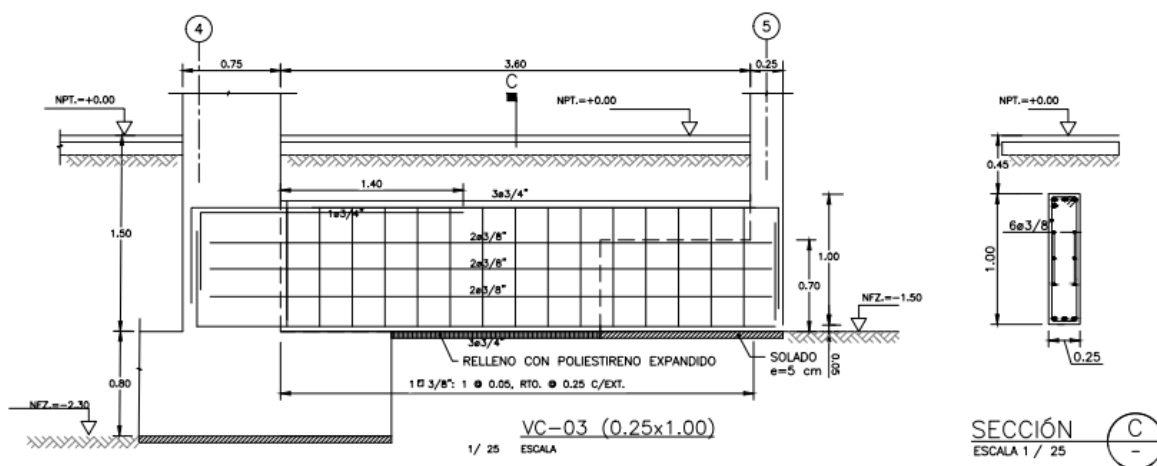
Esquema de distribución de la armadura en viga de cimentación VC-03.
